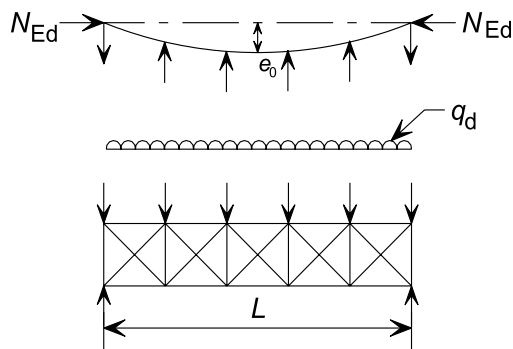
Эквивалентная стабилизирующая нагрузка
